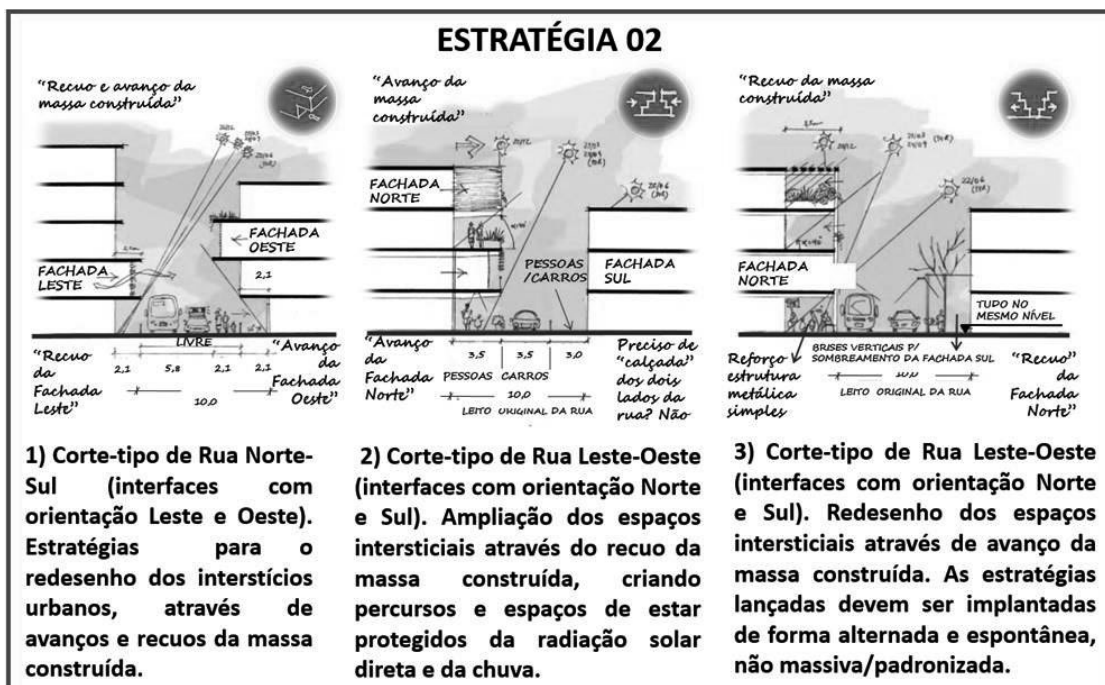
Proposta tipológica de Pizarro (2014) dos recuos e avanços da massa construída (estratégia 02).
